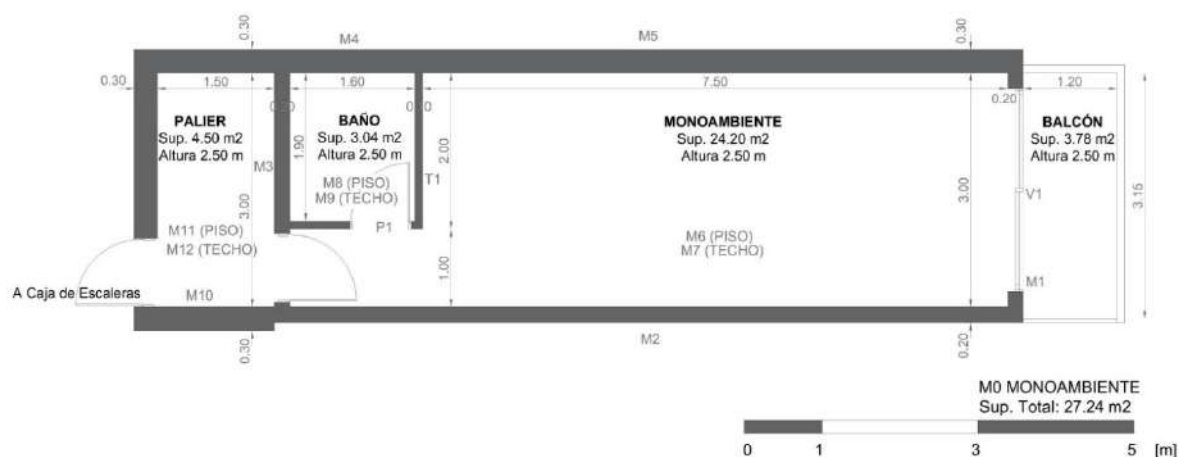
Esquema de planta del módulo M0. Elaboración propia.
